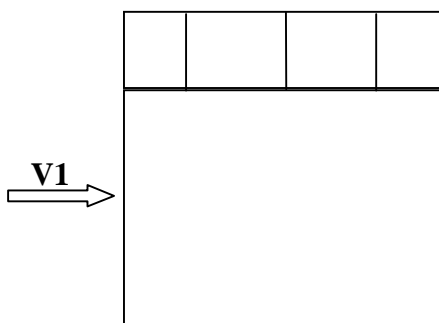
Vent sur la façade principale et secondaire du hangar.
